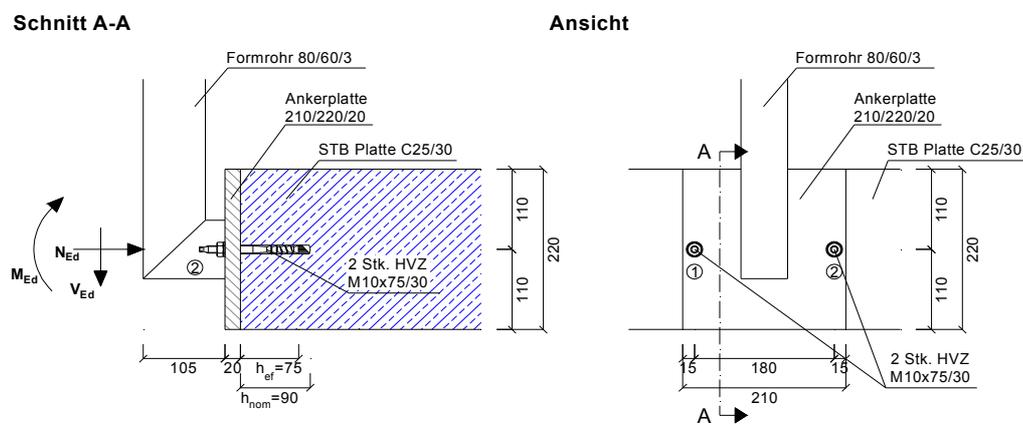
Anschlussdetail G3 Dübel Variante 1 (Maße in mm)
